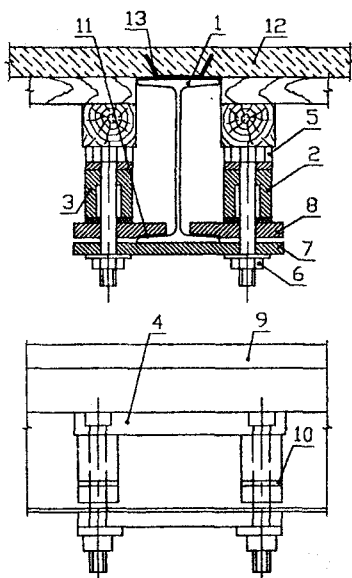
Бетонирование монолитной плиты сталежелезобетонного перекрытия:
